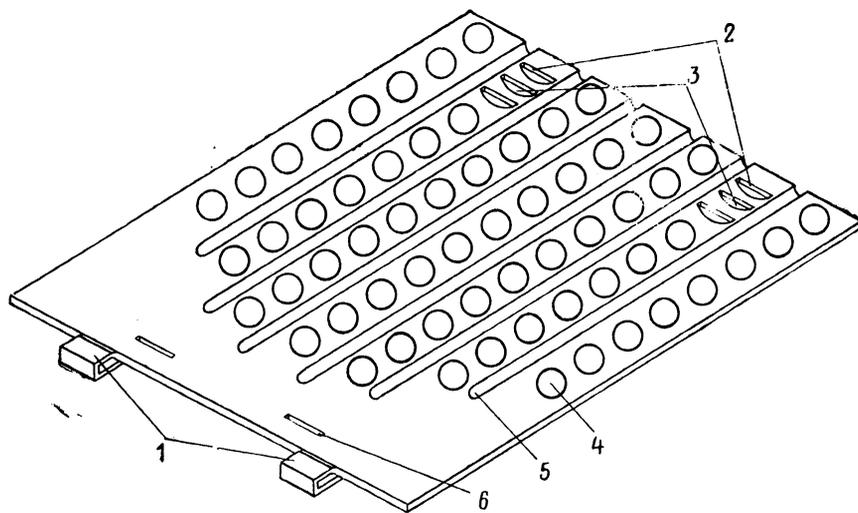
Конструкция плиты для колеяного сборно-разборного металлического покрытия:
